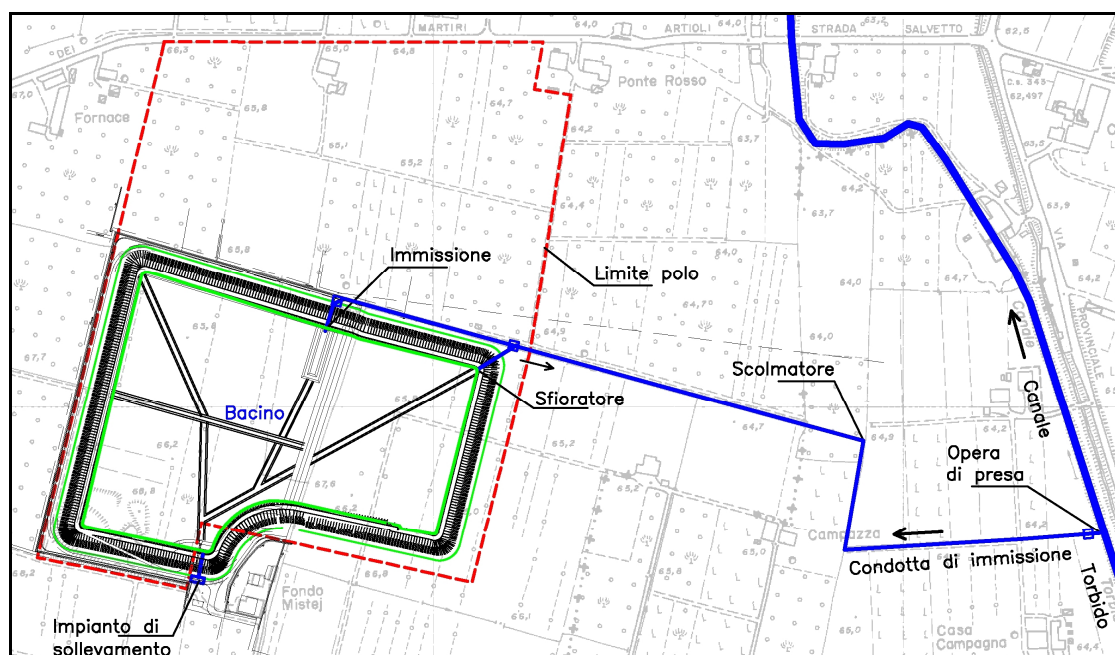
Planimetria d'inquadramento del bacino e della condotta di immissione
